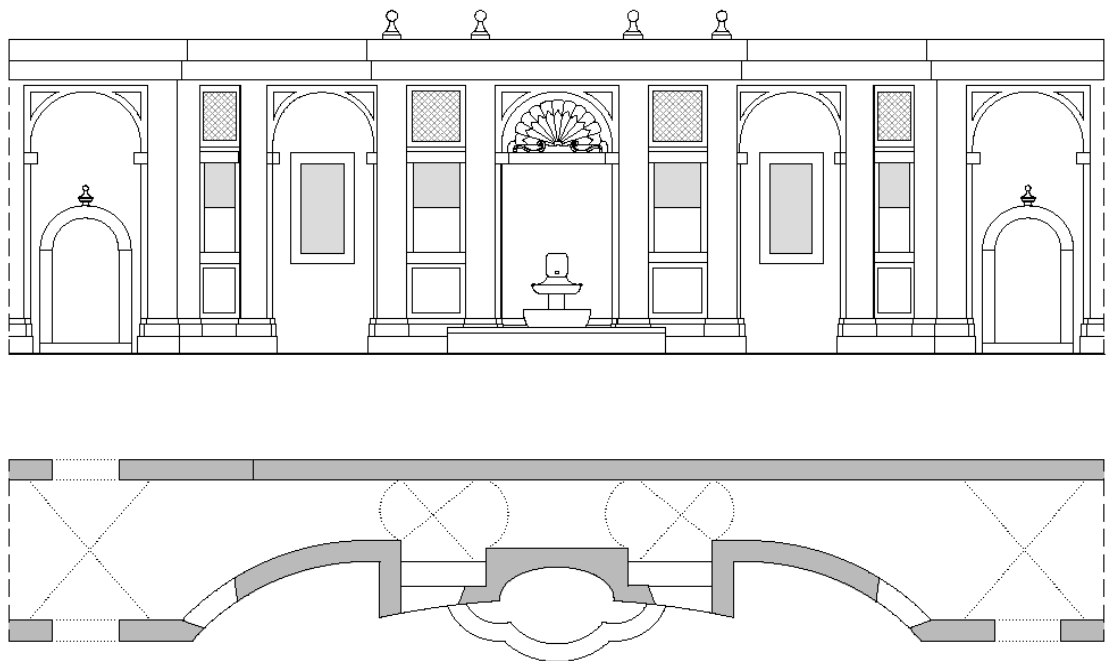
Dibujo de la autora. Alzado y planta de la fuente-pasaje.
